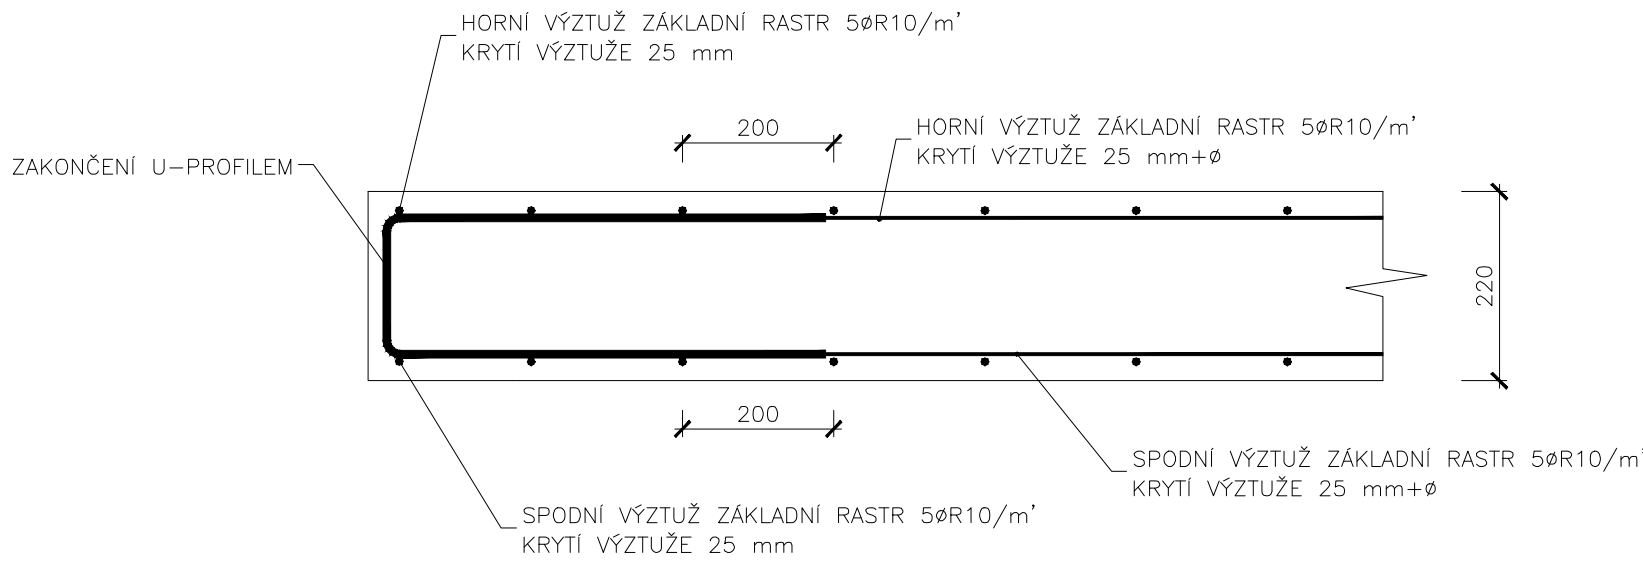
DETAIL KLADENÍ VÝZTUŽE - ŘEZ X M 1:10
